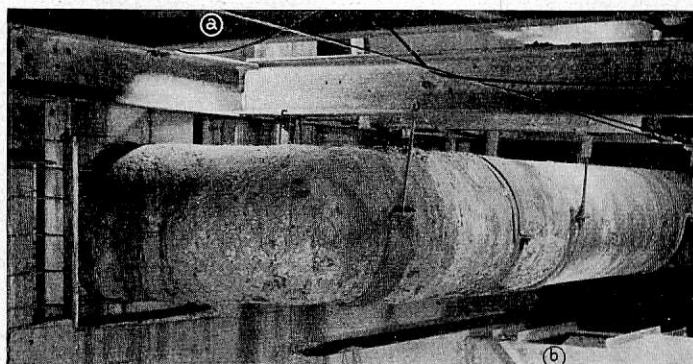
Einführung einer Rohrleitung in die Baugrube mit der Rohraufhängung.
